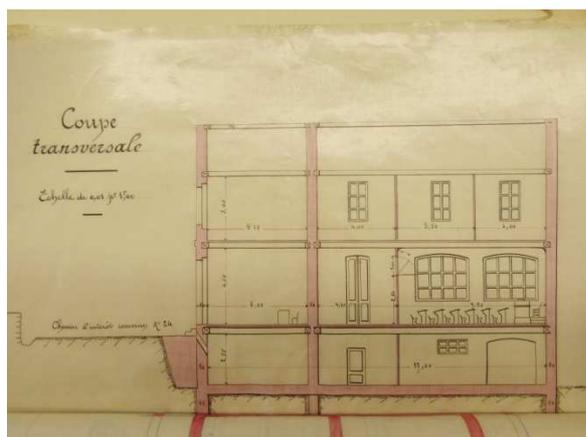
Projet de construction d'une maison d'école avec mairie, coupe transversale, Angeli (conducteur des Ponts et Chaussées).
